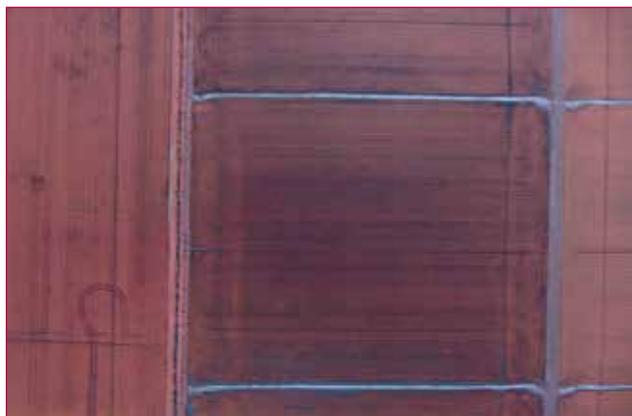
Foto originale ripresa con la camera multispettrale.
